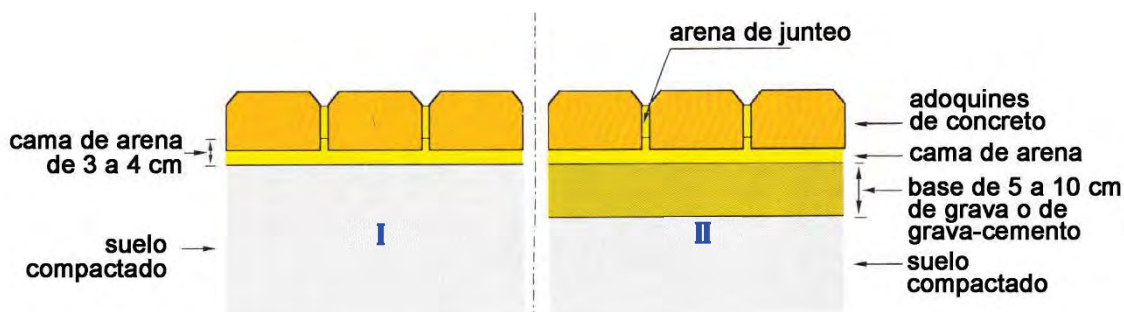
ESTRUCTURA PARA PAVIMENTOS DE ADOQUIN
